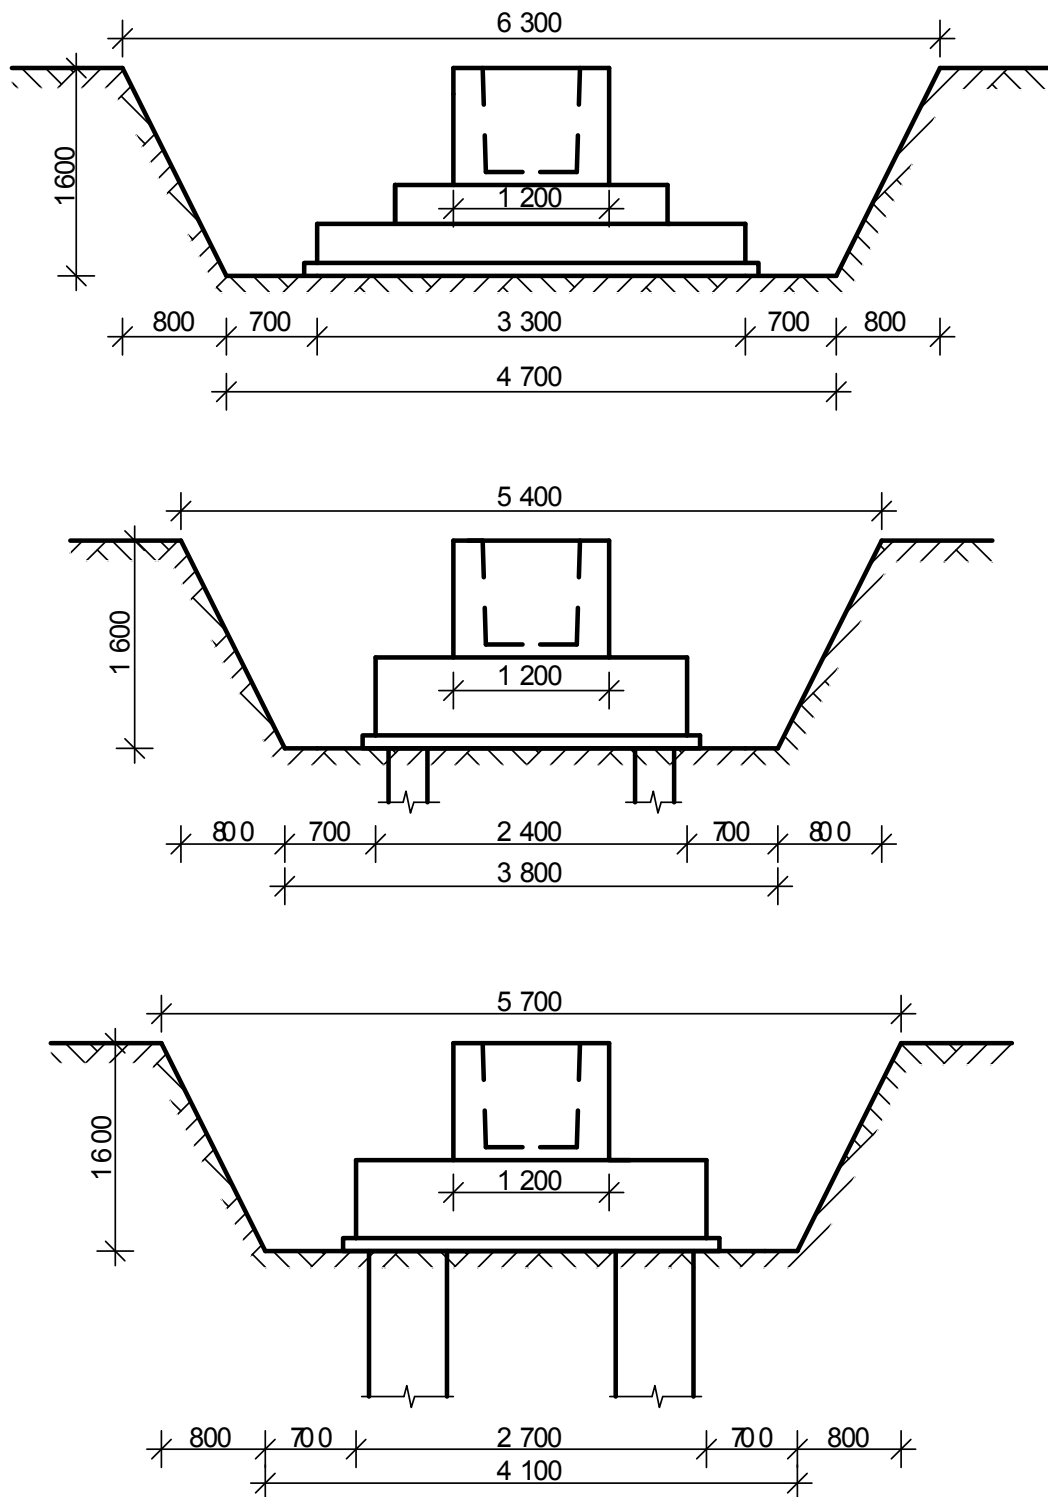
Конструктивне рішення варіантів фундаментів і поперечний переріз траншеї
